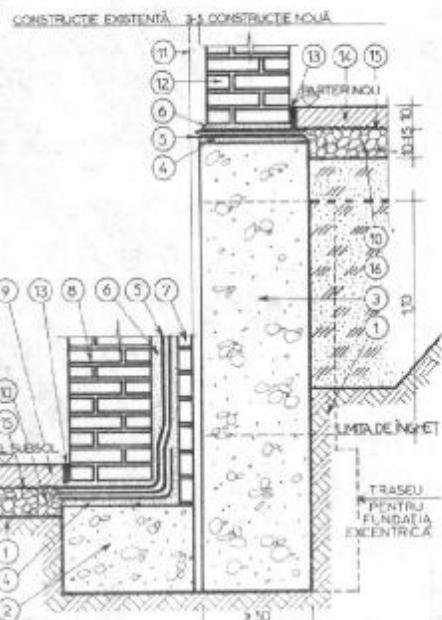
Fundație la o construcție nouă fără subsol, amplasată lîngă o construcție existentă cu subsol.
